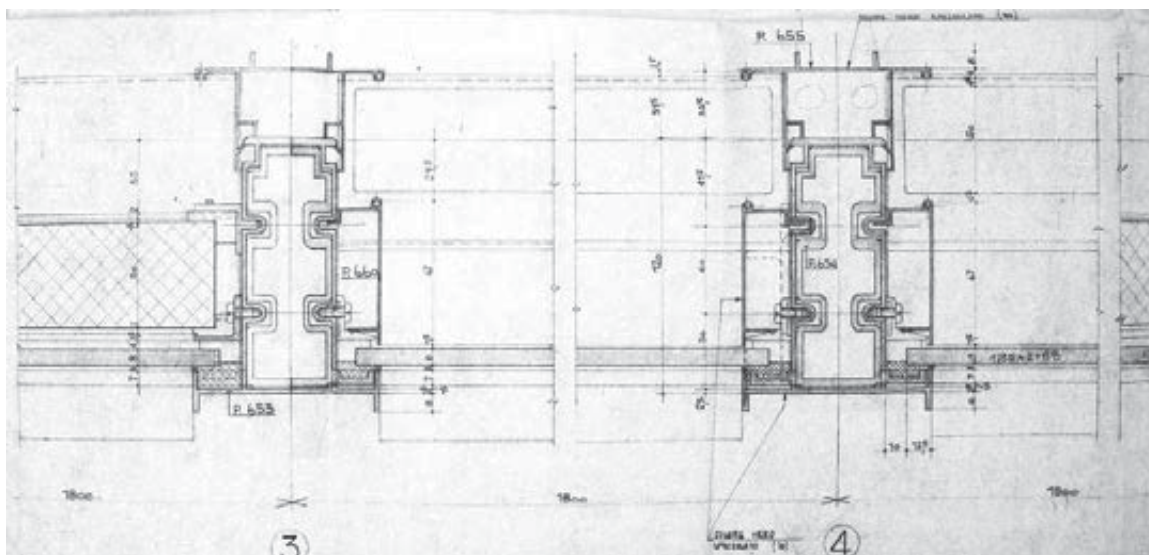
Trancia della sezione orizzontale del curtain wall (ASE)
